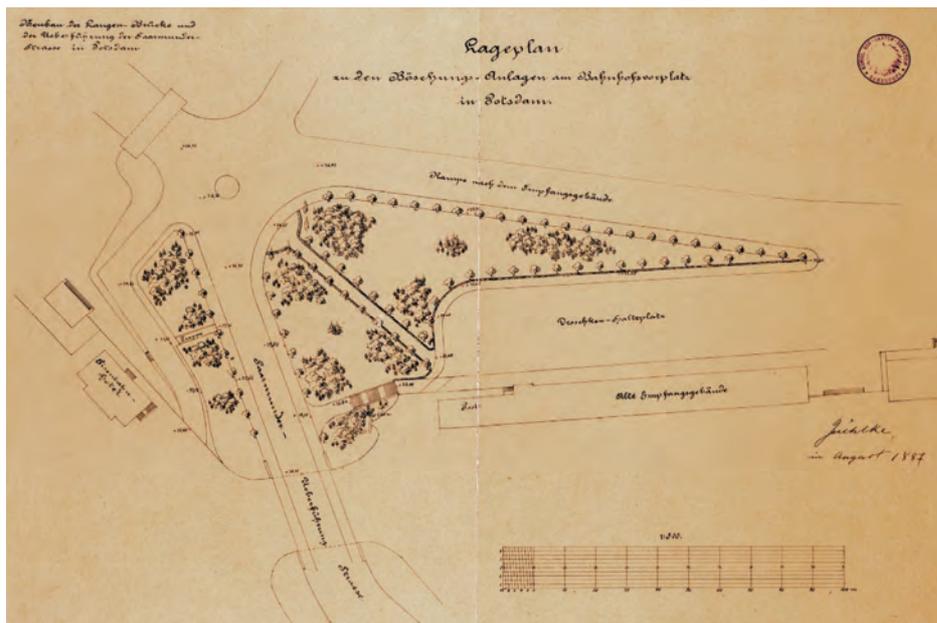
Potsdam, Lageplan zu den Böschungs-Anlagen am Bahnhofsvorplatz in Potsdam. Neubau der Langen Brücke und der Ueberführung der Saarmunder Straße in Potsdam, Federzeichnung, ca. 40 x 60 cm, M 1:500, signiert u. r. Jühlke, August 1887, SPSP, Plansammlung Nr. 11019
